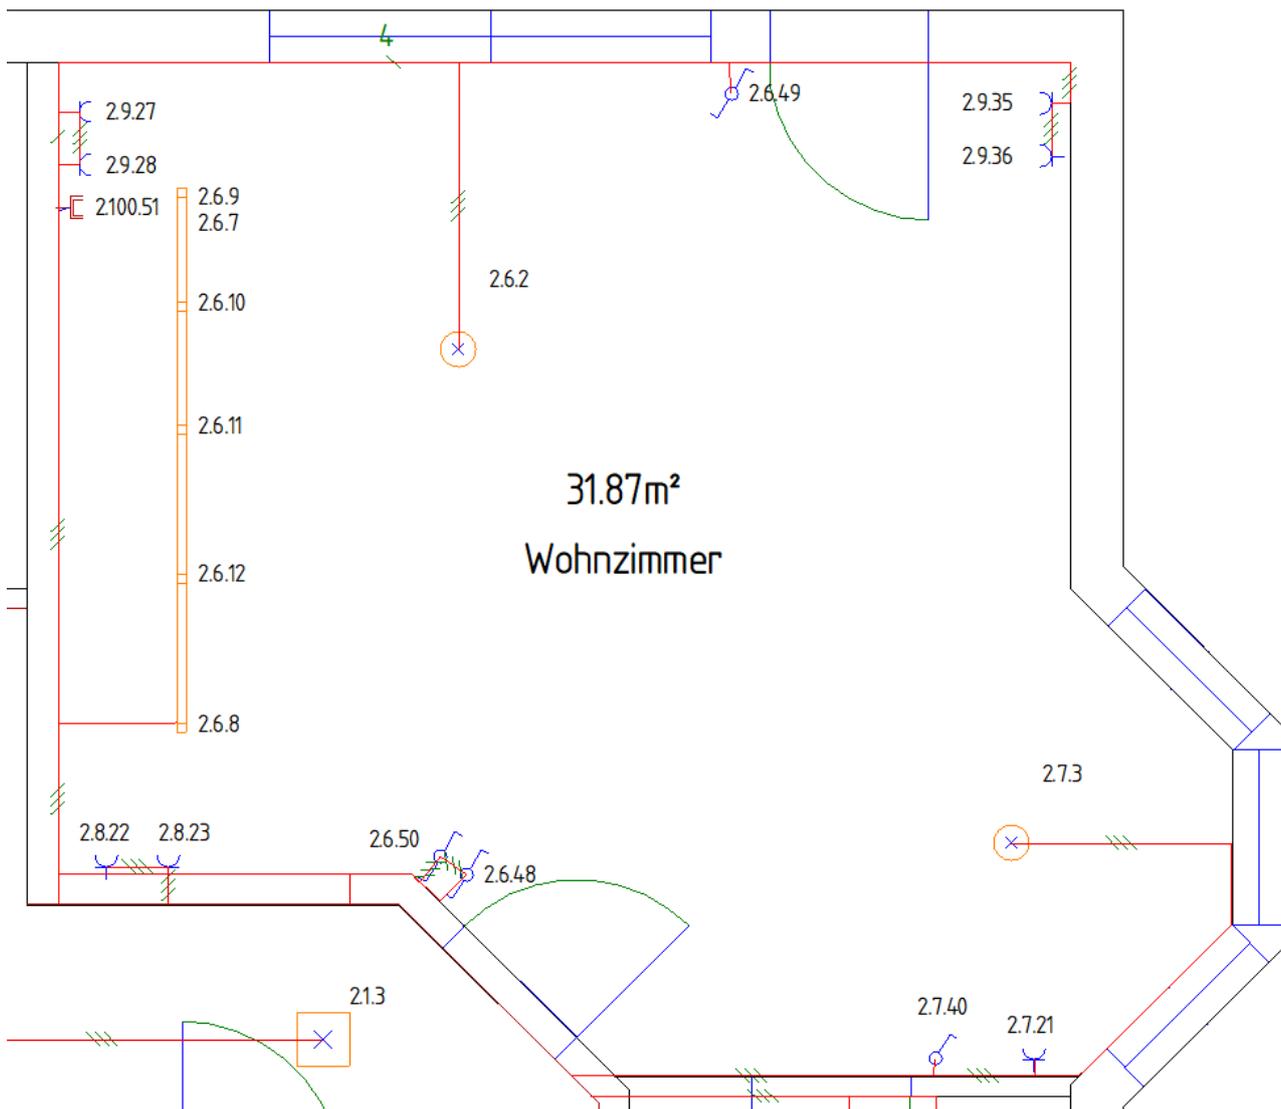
Ausschnitt Grundrisszeichnung nach dem Beschriften
